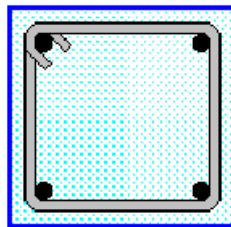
Número mínimo de varillas longitudinales en columnas rectangulares.
